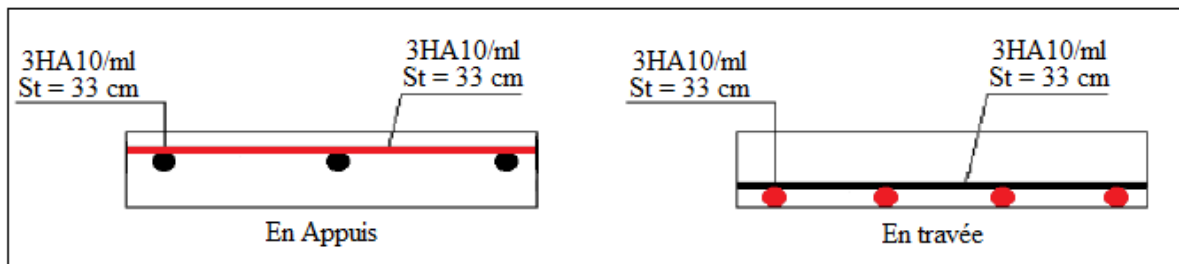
Schéma de ferrailage de la dalle de l'ascenseur.
